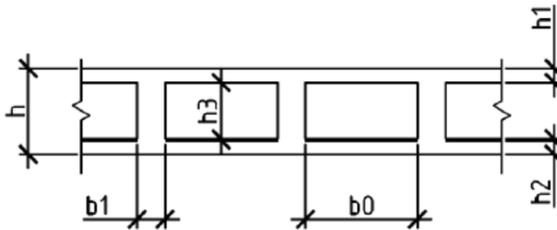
Схема геометрических размеров поперечного сечения плиты перекрытия с несъемными пустообразователями
